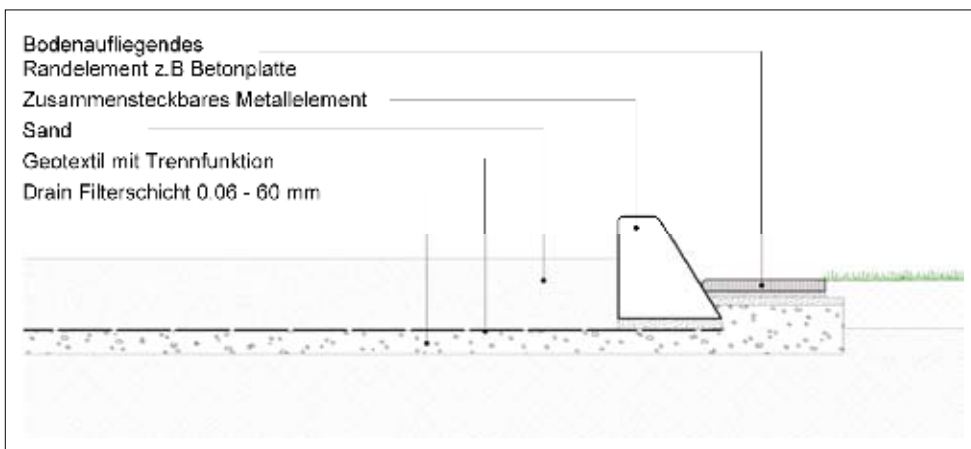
Systemschnitt für eine Randeinfassung mit Metallelementen
